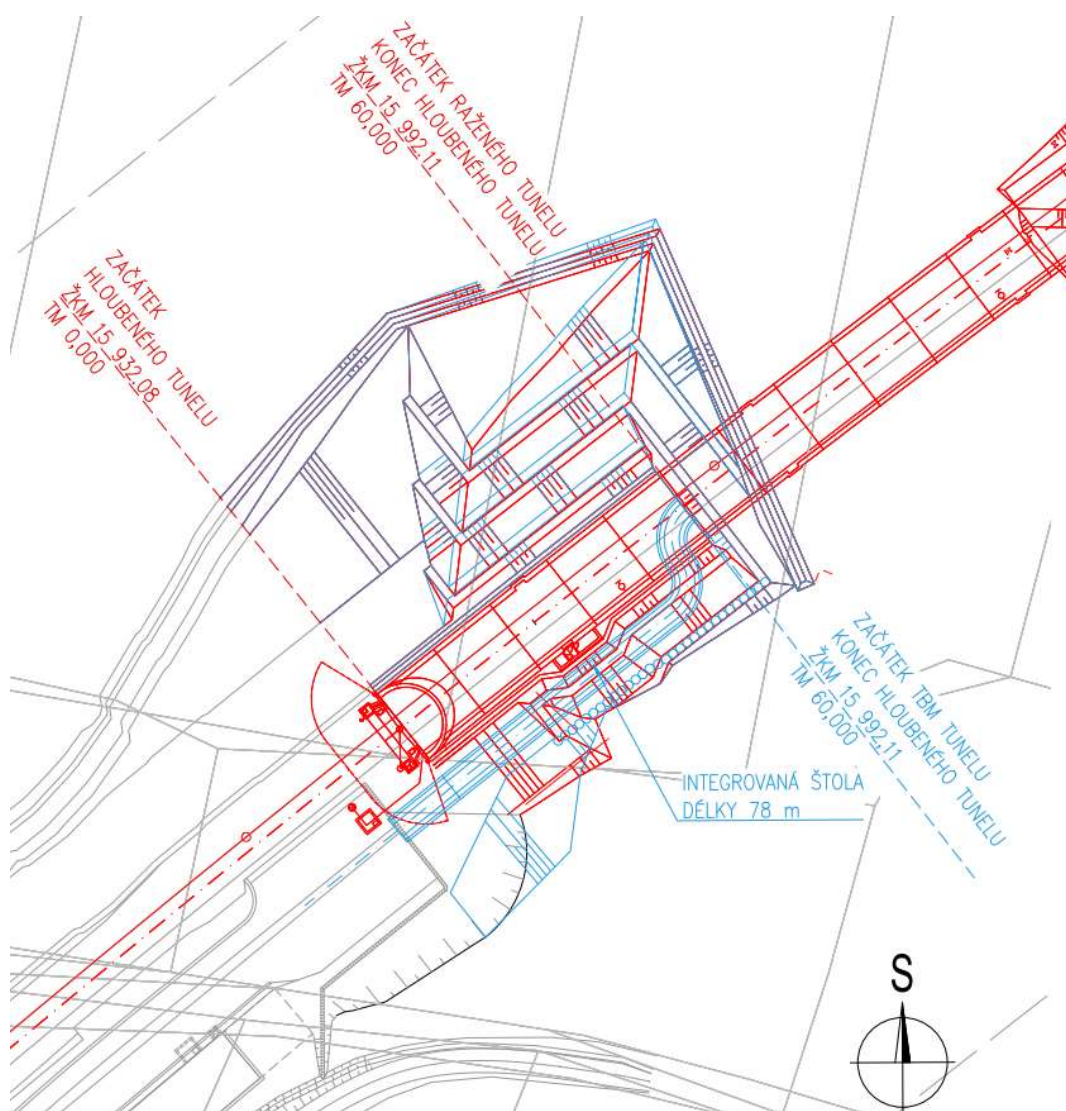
Výkop stavební jámy – výjezdový portál Hosínského tunelu
